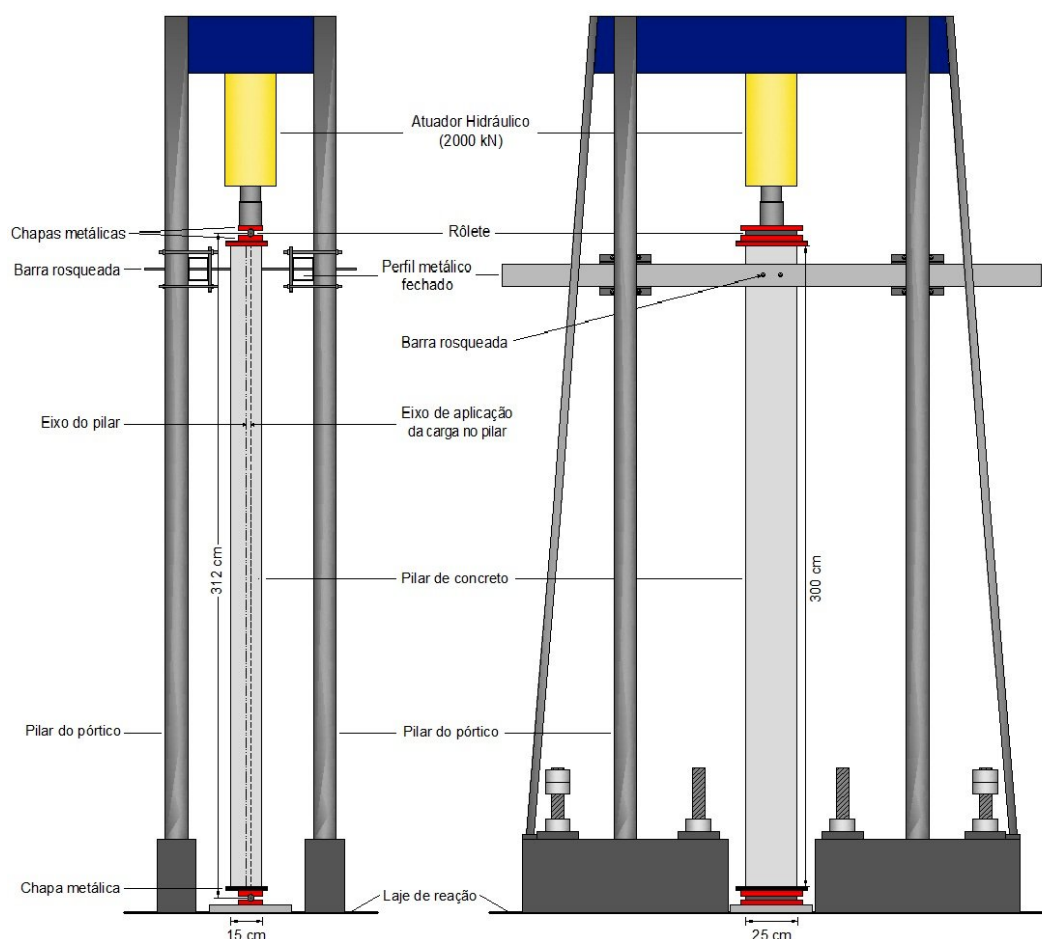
Esquema do equipamento de ensaio e montagem do pilar
